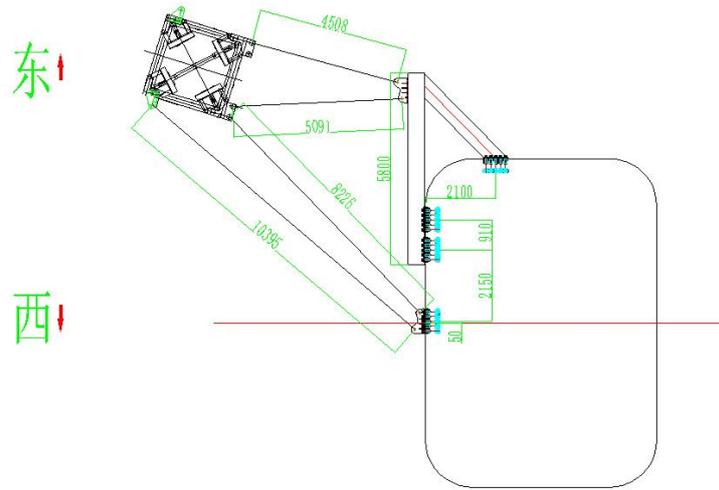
3#塔机第三, 四道附着平面布置图
